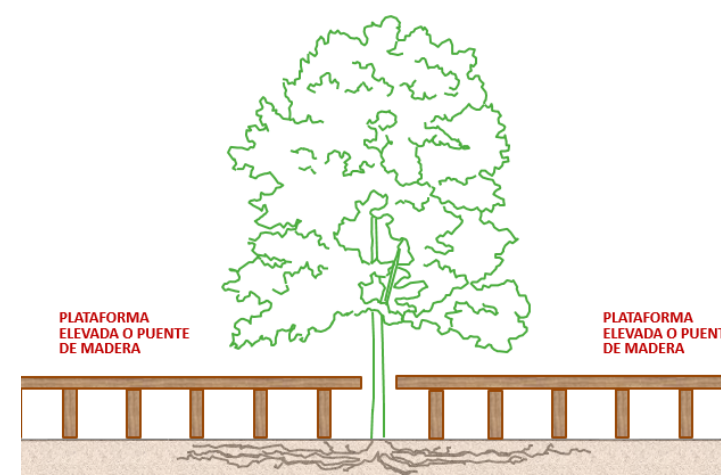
Plataforma de madera elevada. Fuente: Tecnigral
